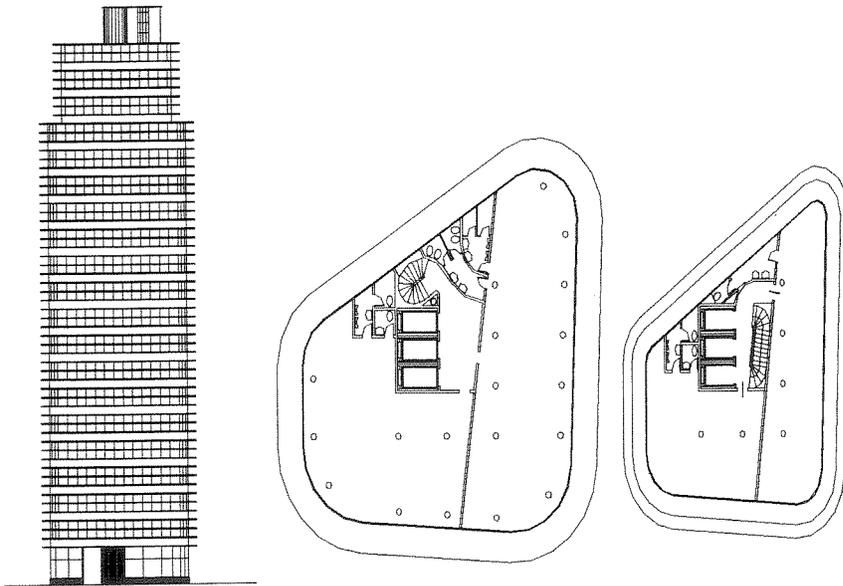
Segundo projeto apresentado à Prefeitura. Elevação e planta-tipo.
